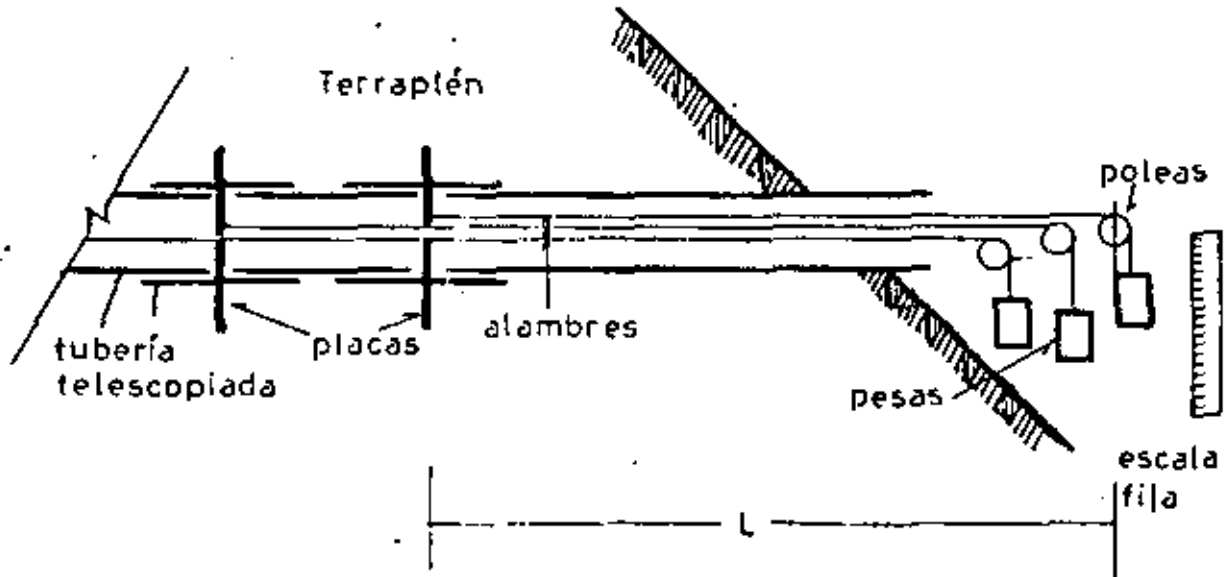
EXTENSOMETRO MECANICO DE ALAMBRE
